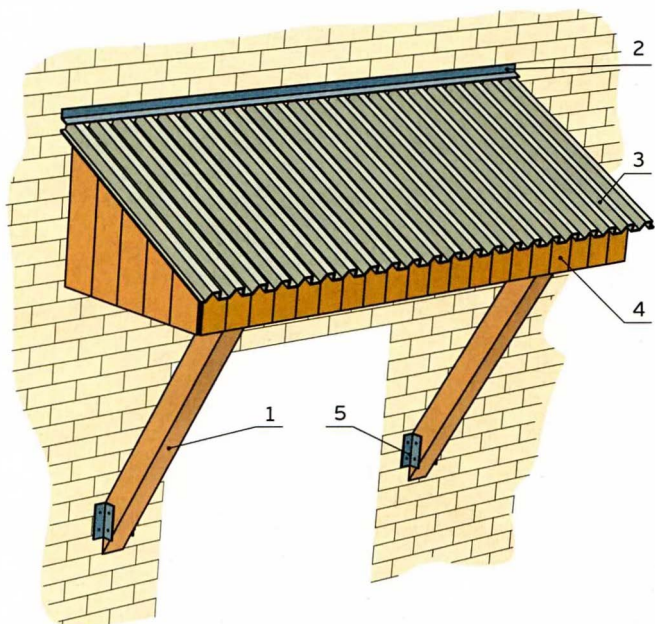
Козырёк в сборе: 1 — стойка; 2 — уголок из оцинкованного железа; 3 — кровля; 4 — обшивка; 5 — металлический уголок.
